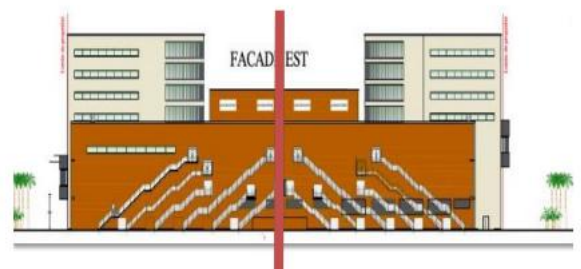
façade est du centre commercial de Bab Ezzouar.
